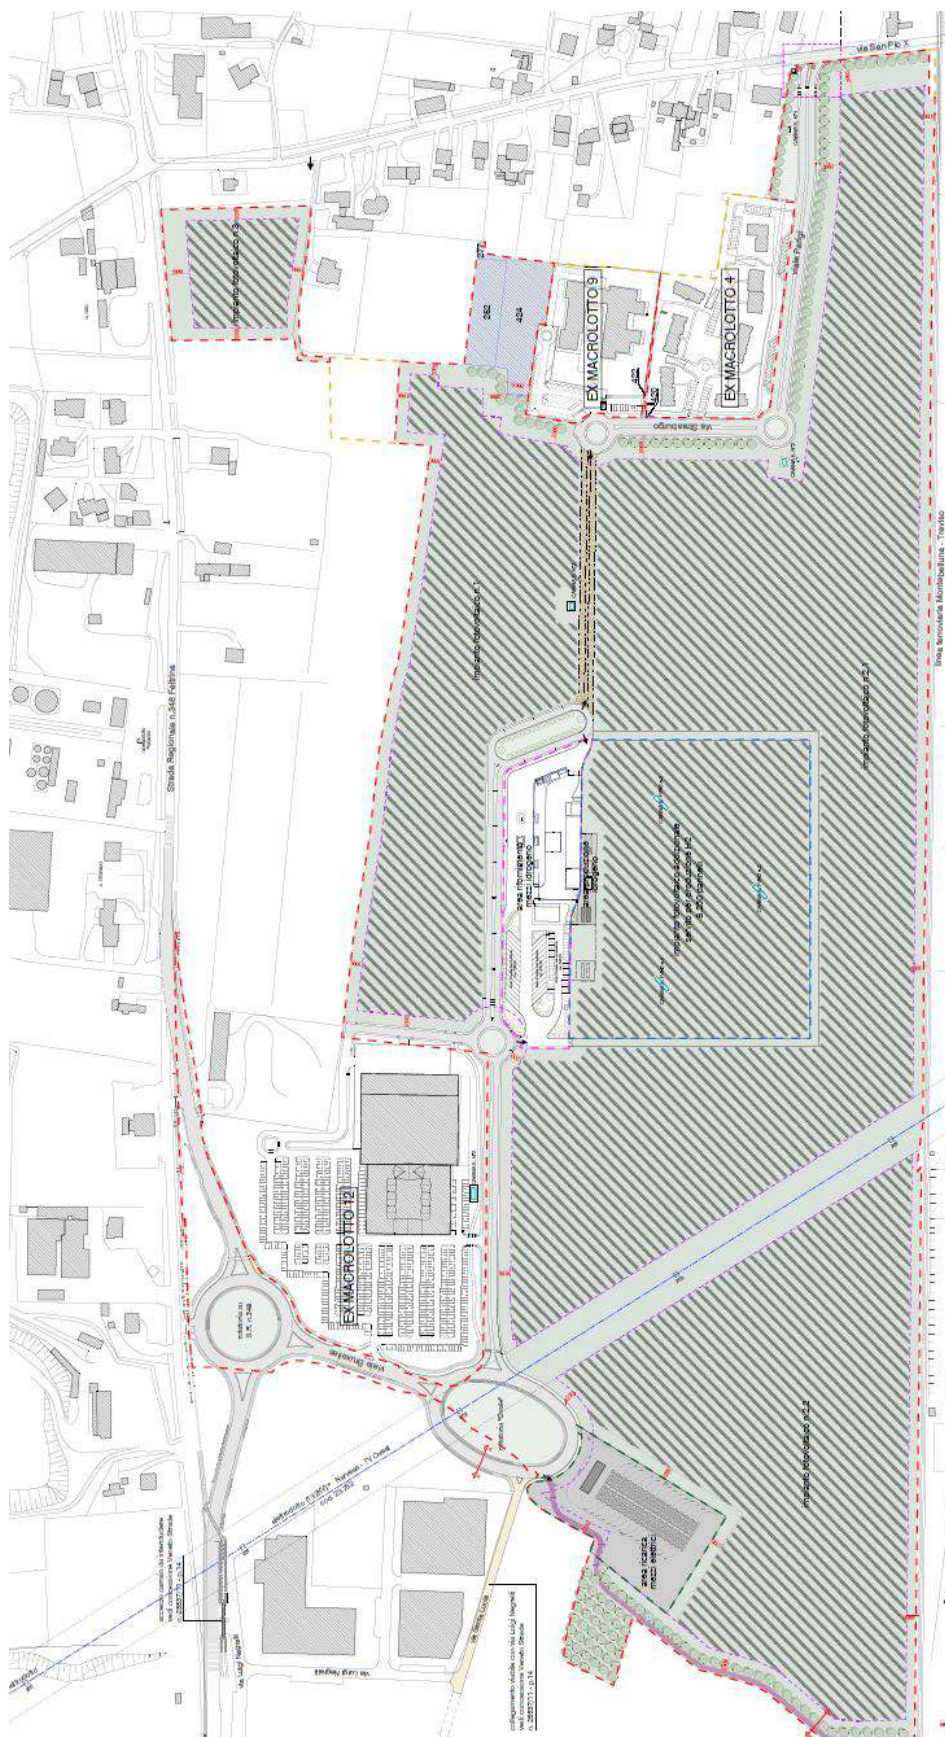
Estratto della planimetria generale della proposta di accordo in variante agli strumenti urbanistici vigenti
